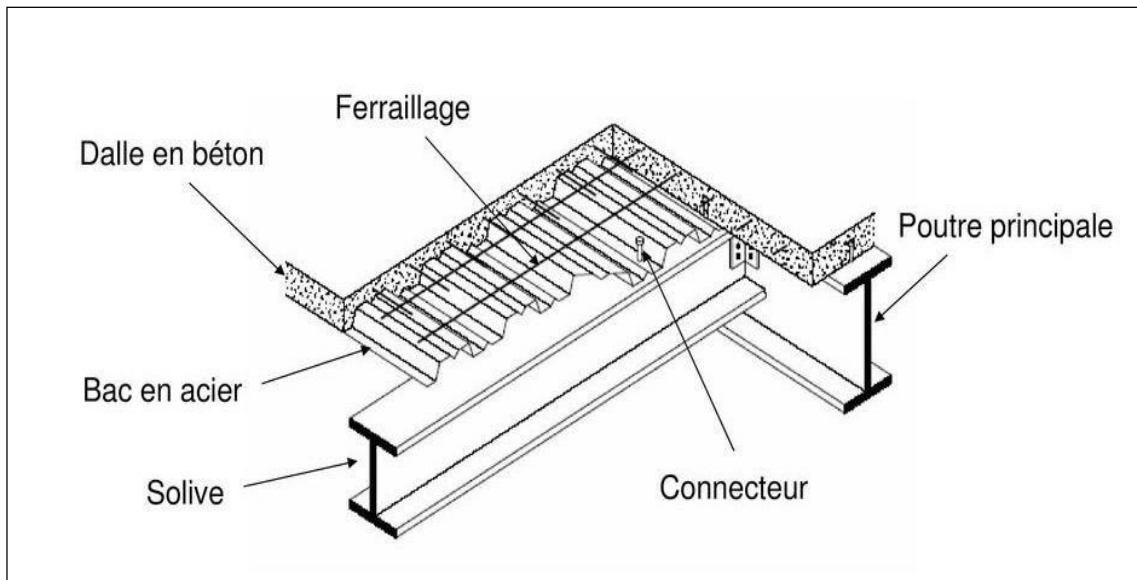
Eléments constructifs d'un plancher collaborant.
